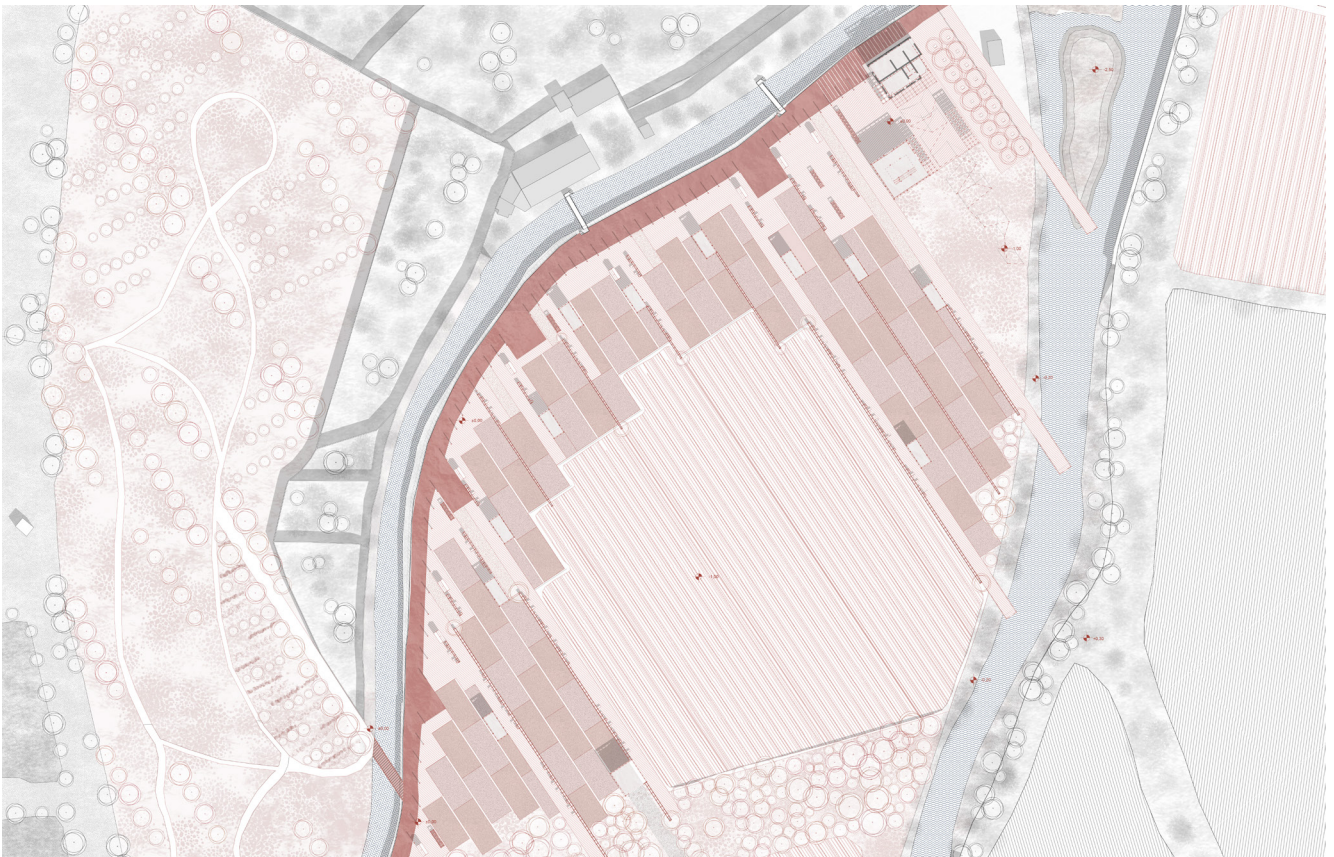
Pianta cascina Lambro - stato di progetto (nostra elaborazione)
